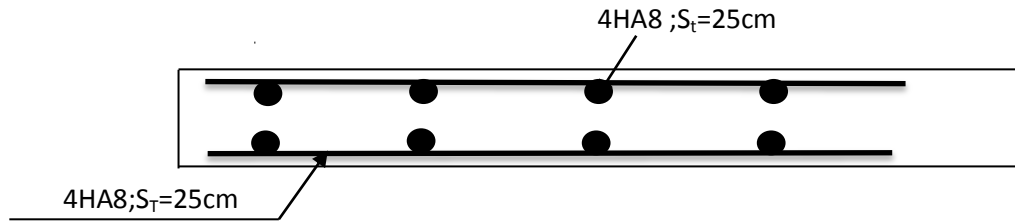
Schéma de ferrailage de la dalle sur 2 appuis.
